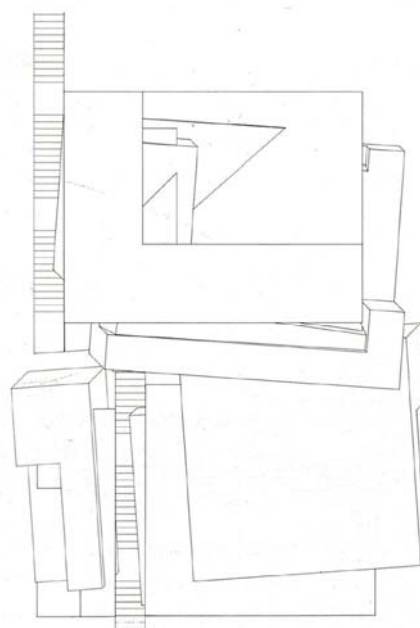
Planta piso de acesso (Levene, et al., 1989 p. 75)
